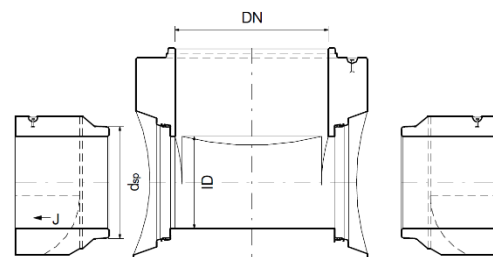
Anschluss mit MAROWA Röser Hochleistungsbetonrohren mit Gefälle J ≤ 150 ‰
